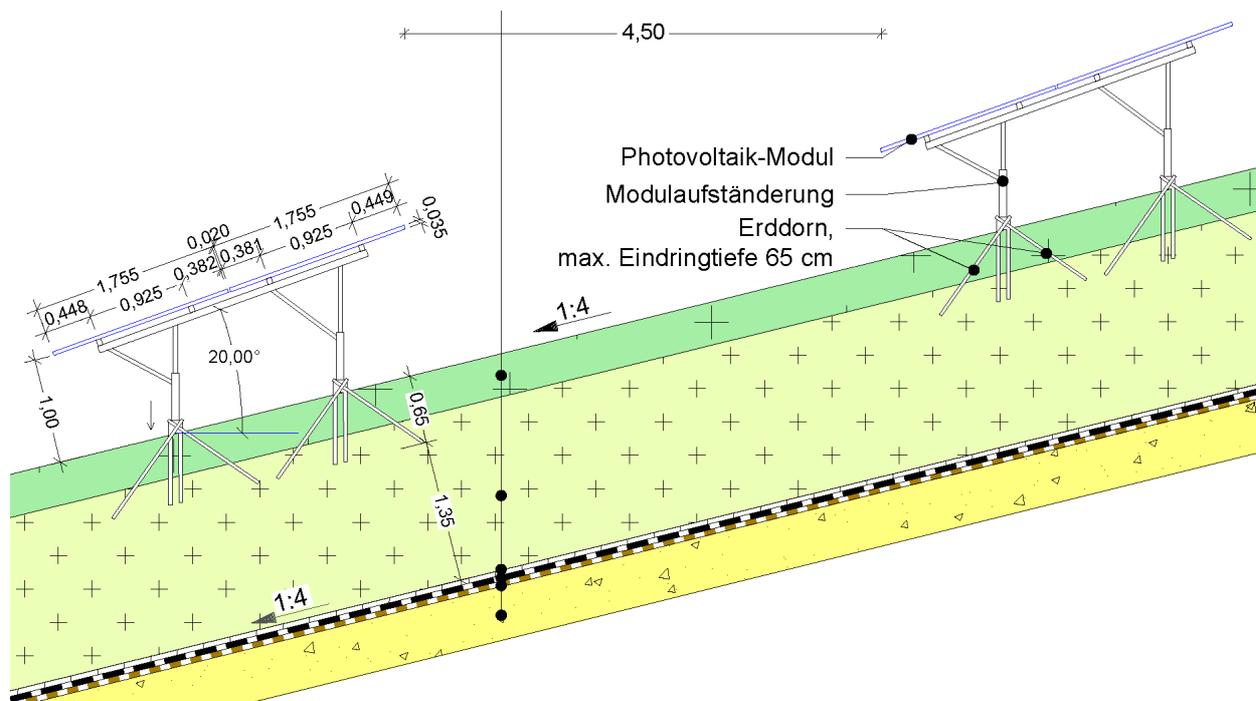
Detailplan Modultisch und Gründung (Quelle: SIG-Hessen Ingenieure, ohne Maßstab)
